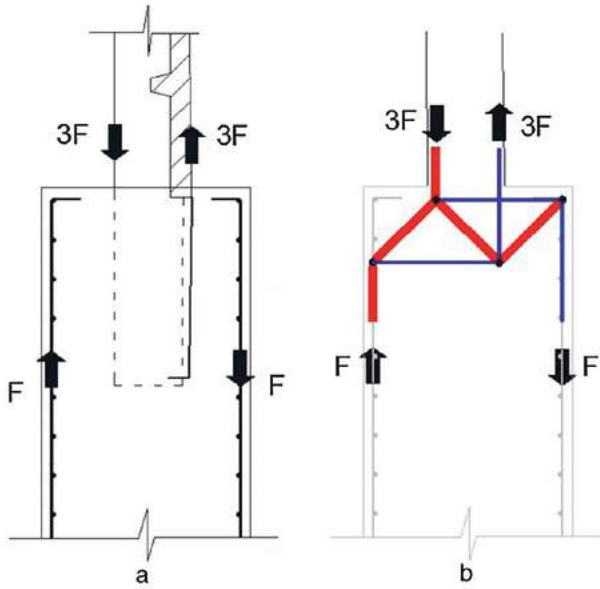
Esquemas de modelos de bielas y tirantes aplicables para la conexión entre paneles prefabricados y muros de hormigón armado.
